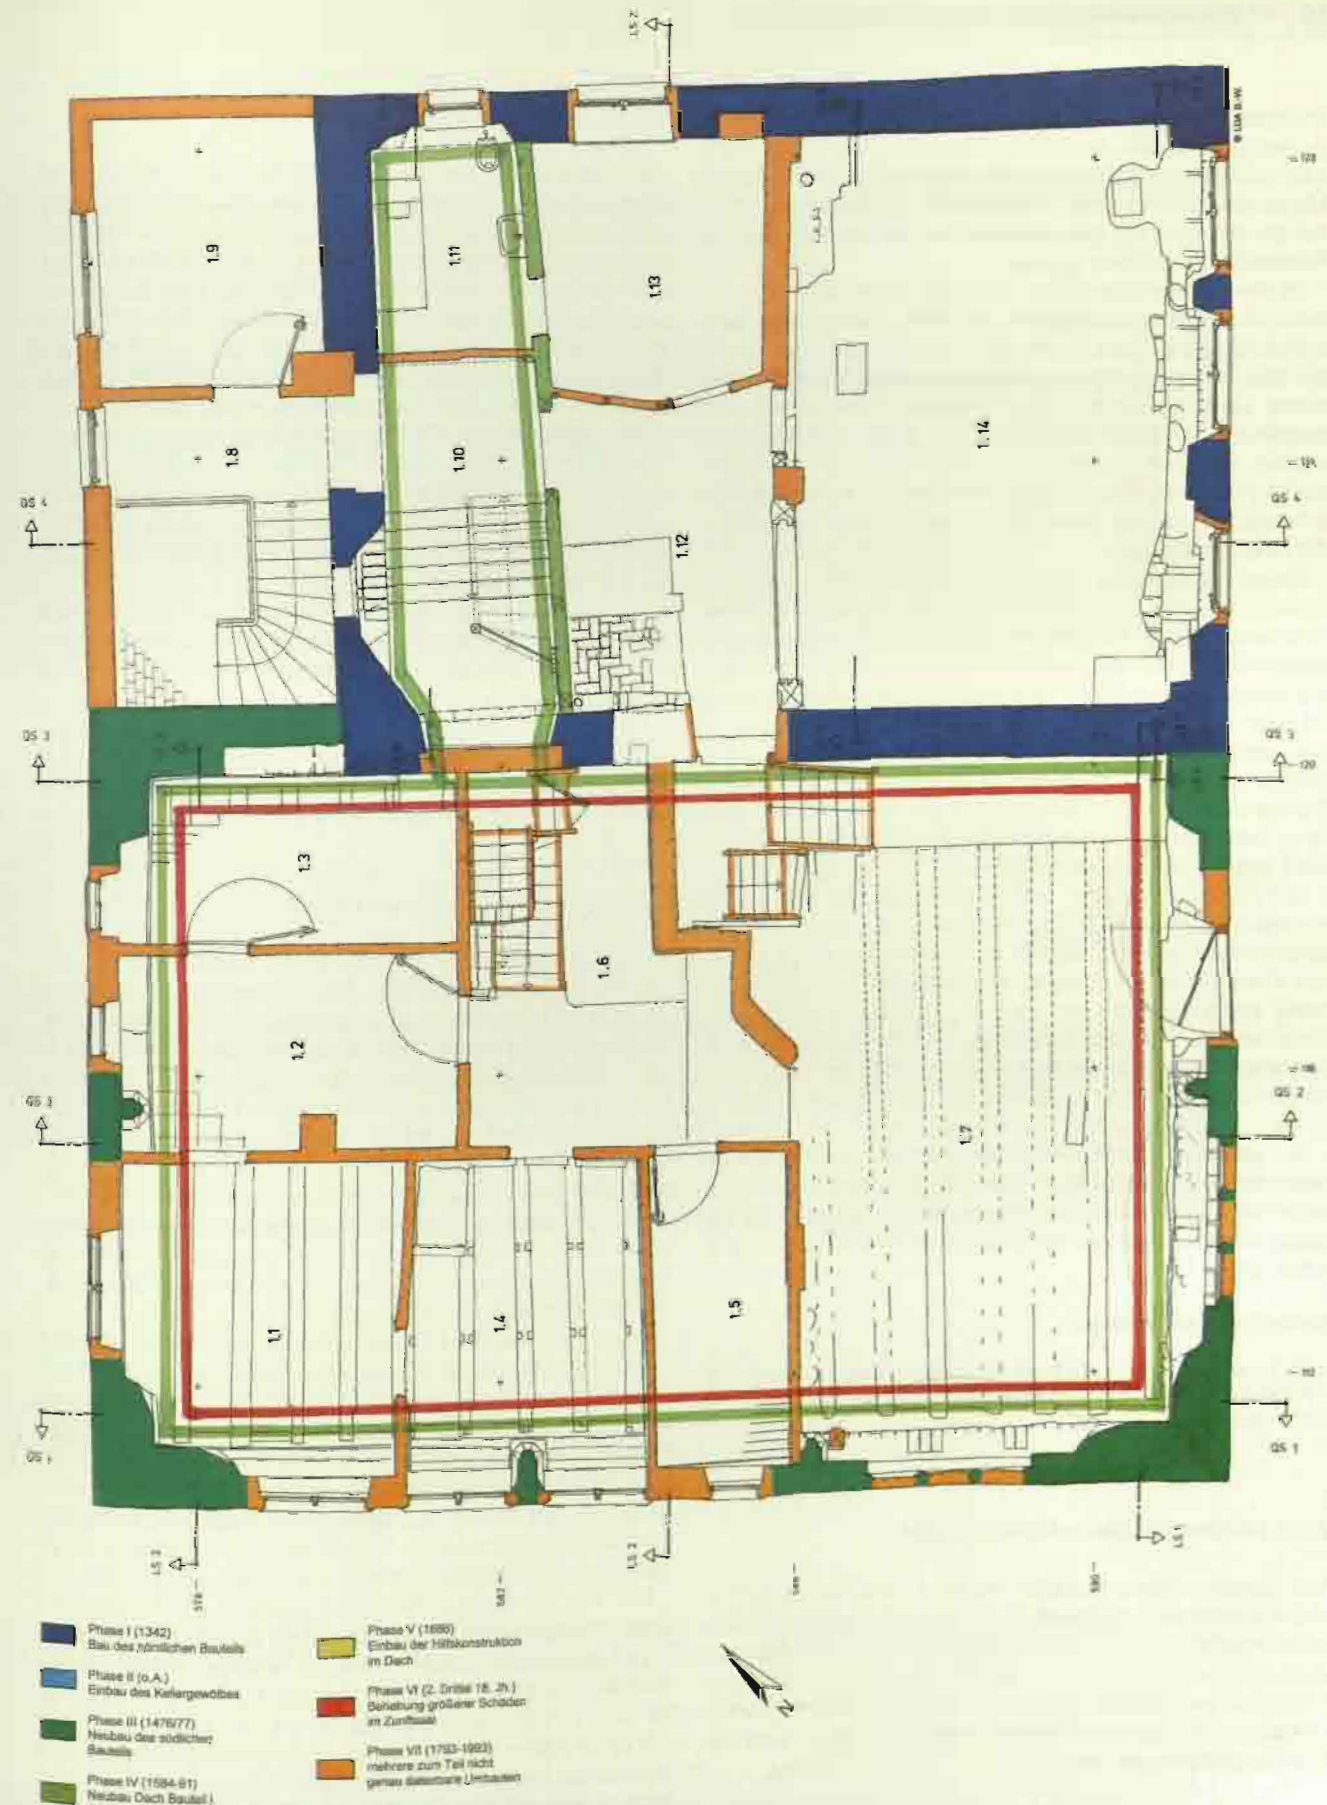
Baualtersplan. Wangen, Zuntzhausgasse 11, Grundriss 1. OG. Bauaufnahme, Handaufmaß im Maßstab 1:20, verkleinert auf Maßstab 1:125. Abfolge der Bauphasen mit Kennzeichnung der Restaurierungsphasen im ehemaligen Zuntzsaal.
